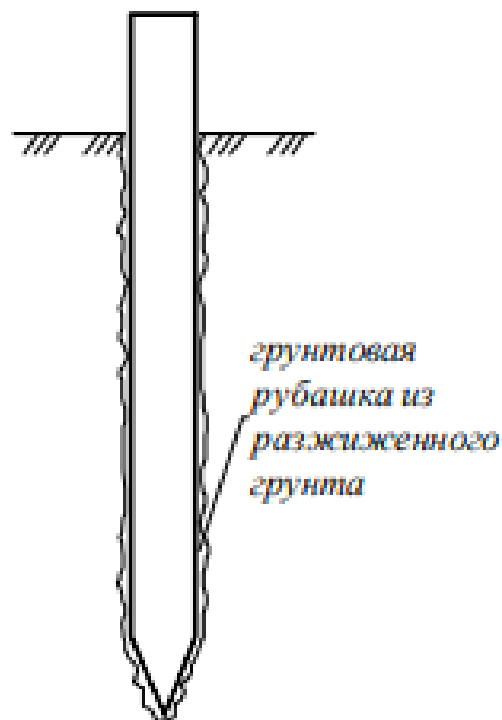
Грунтова сорочка з розрідженого ґрунту
